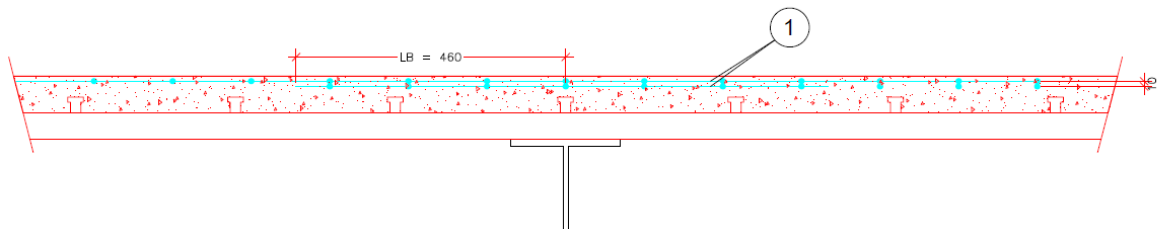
Plano das vigas mistas, conforme dimensionamento apresentado na seção 4.3.
